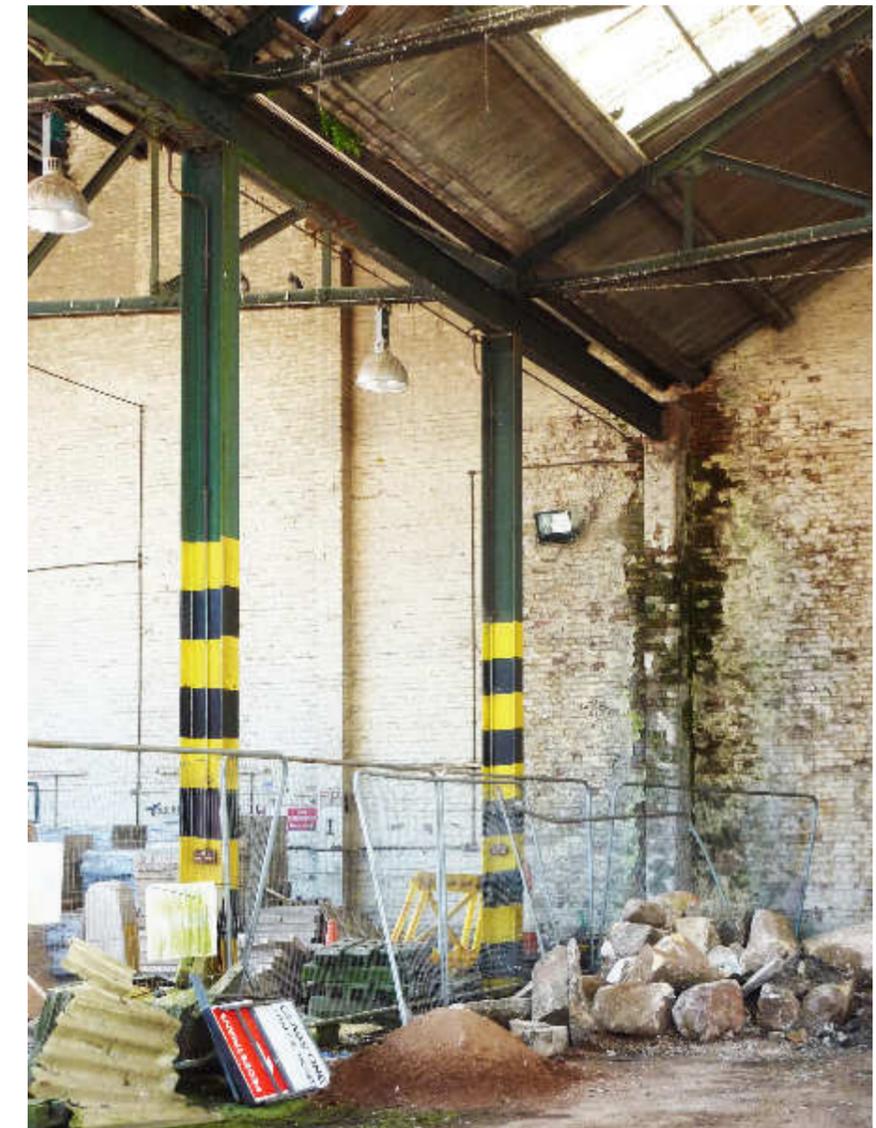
Die tragenden Säulen der Dachkonstruktion
